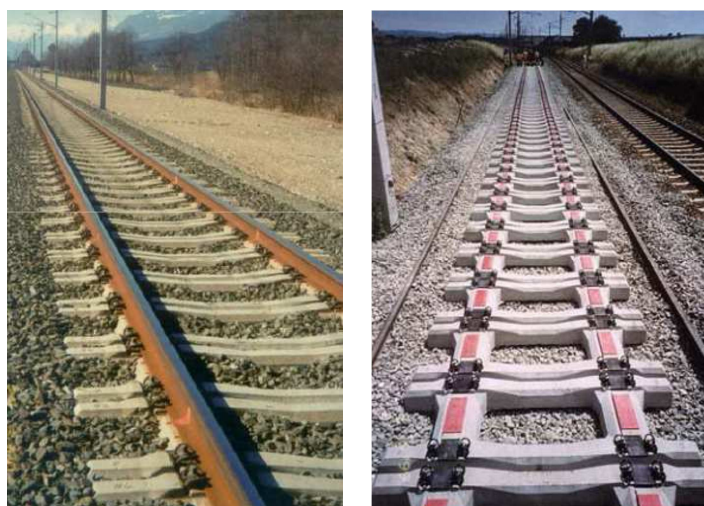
Solução austríaca de travessas, Sleeper-frame [Fontul, 2010; Paixão e Fortunato, 2009]
